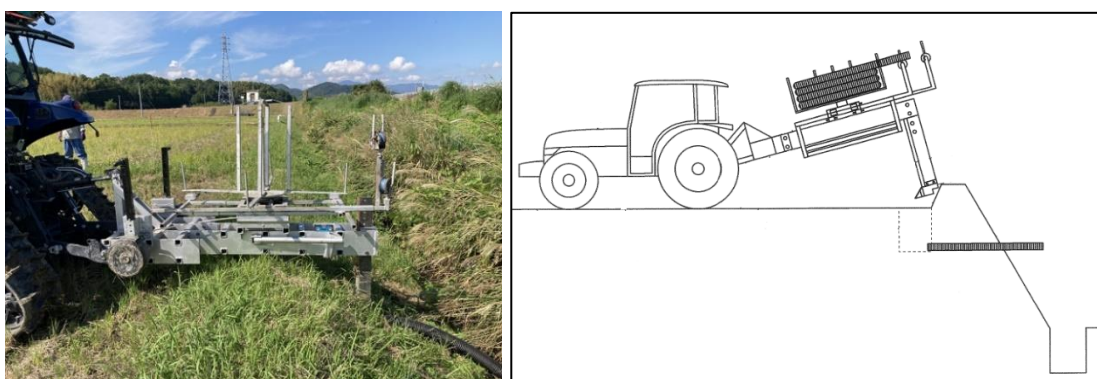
落水口施工の様子（左：施工中、右：施工完了時の状態）
